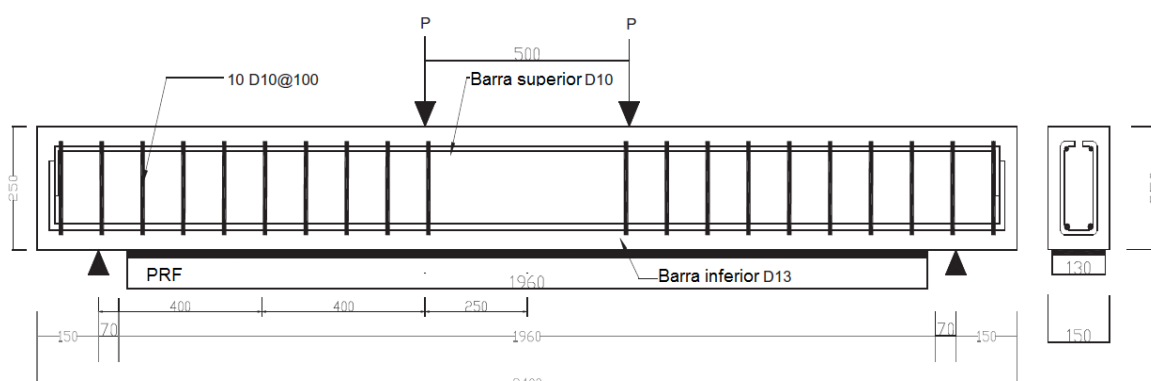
Detalhe de esquema de reforço das vigas (Sun Kim e Soo Shin, 2010)
